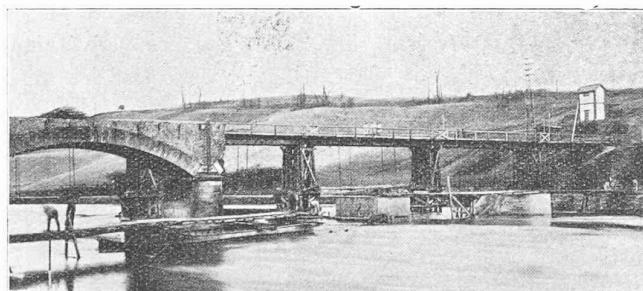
Au premier plan, ancien pont miné. Au deuxième plan, pont provisoire pour une voie, sur un nouveau tracé, à cause d'un tunnel voisin non réparable (1914).
